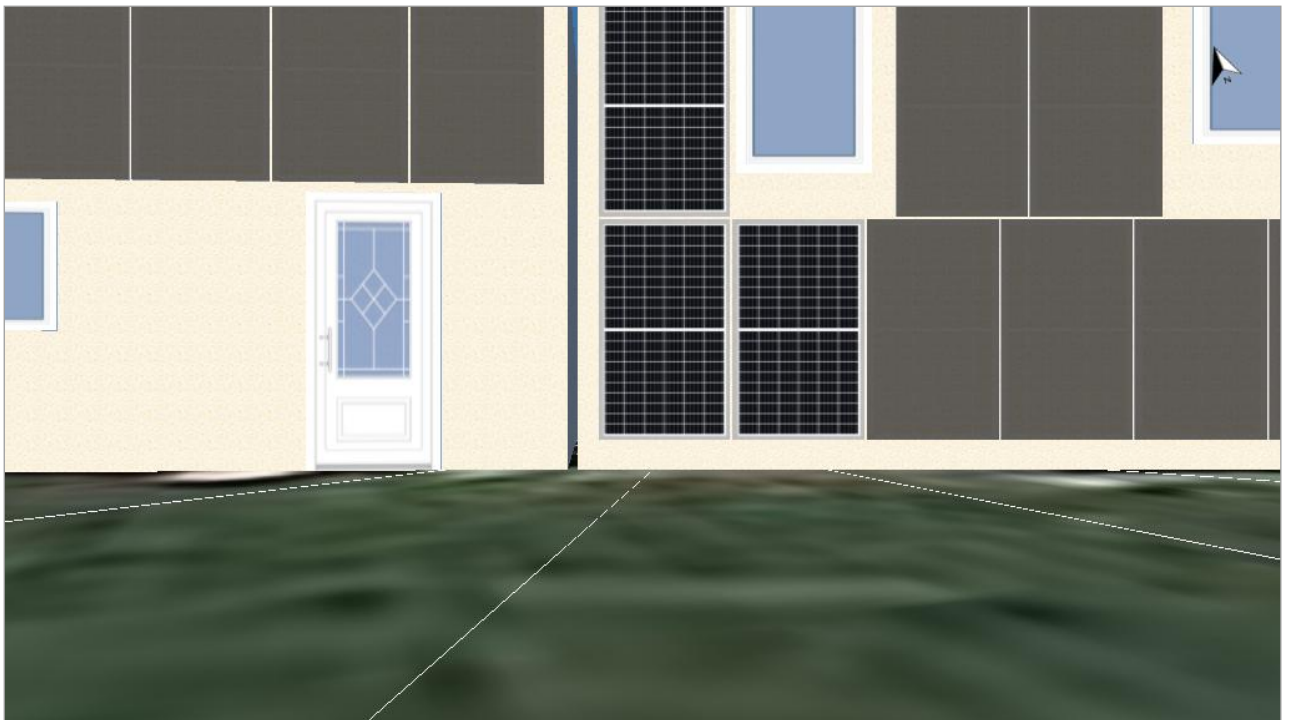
Modulfläche - Gebäude 02-Fassade Süd
